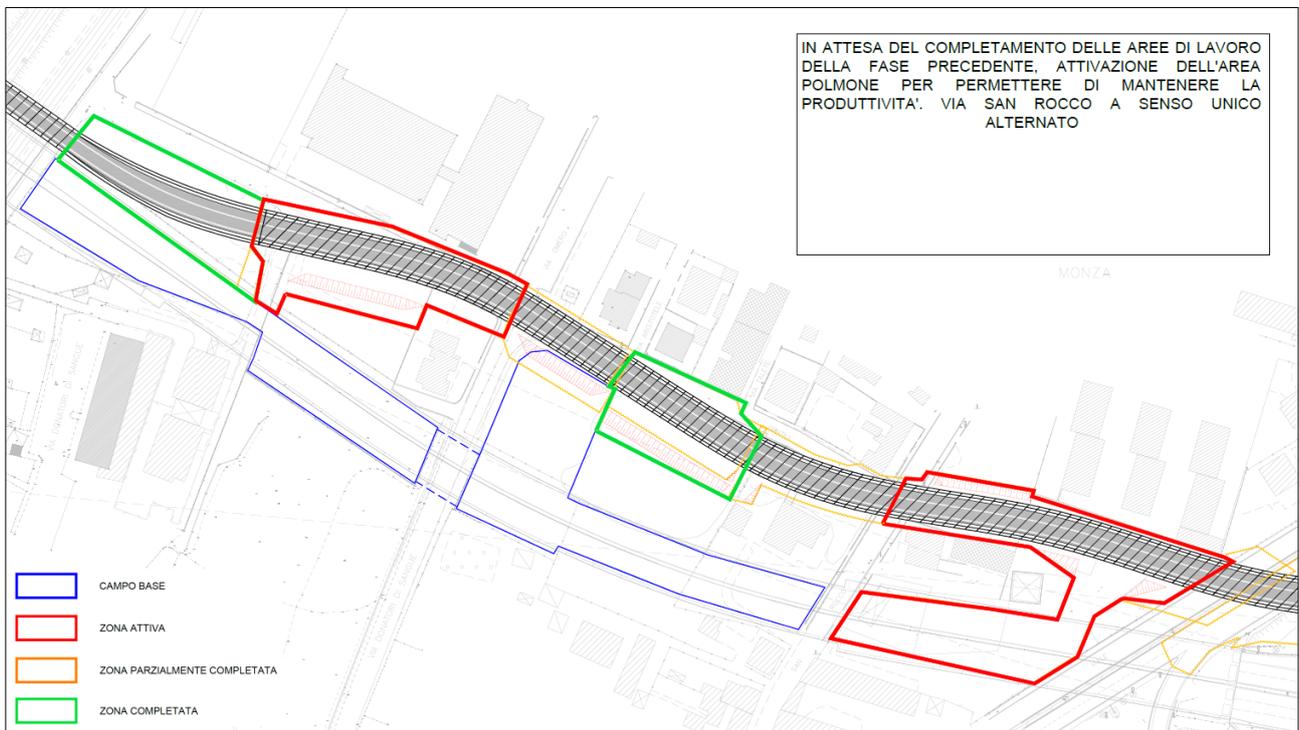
Fasi realizzazione copertura galleria del Piano di Sicurezza di progetto illustrativo della fase D di scavo della galleria
